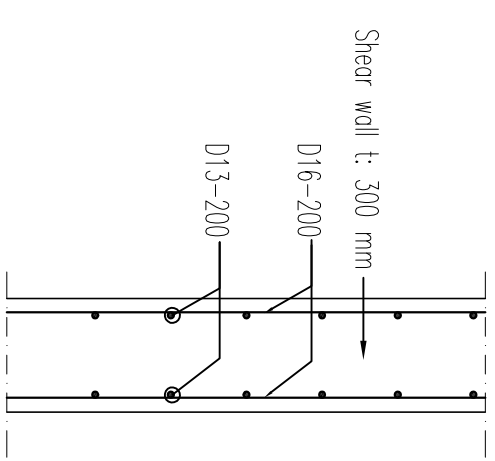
DETAIL PENULANGAN SHEAR WALL TANGGA
